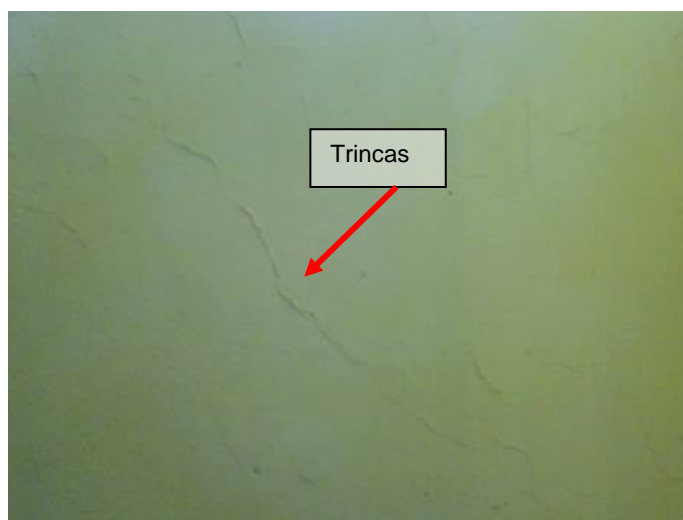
C: Vista de trincas da parede do jardim de inverno.
